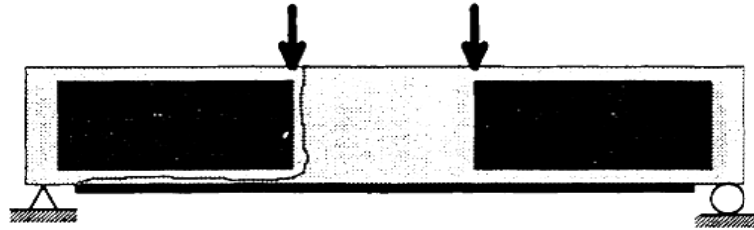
Collage de plaques sur les parois verticales de la poutre (24).
